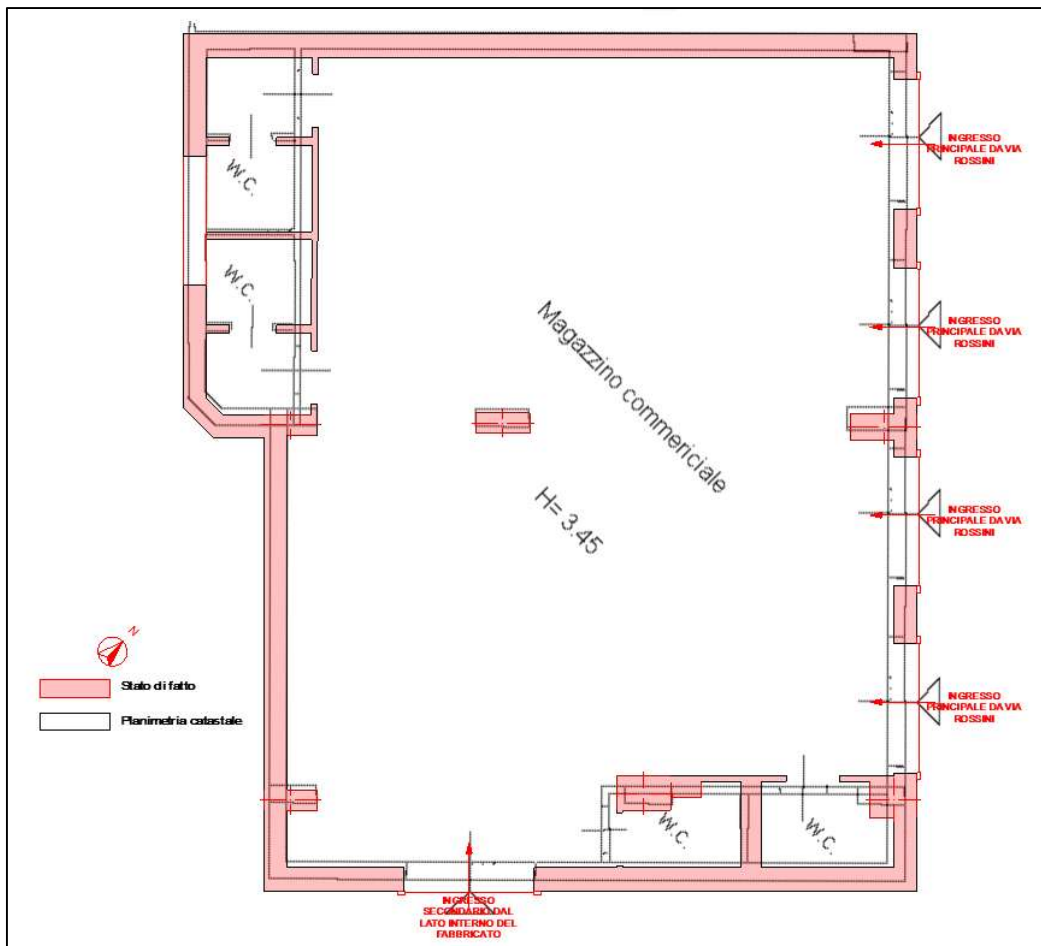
Sovrapposizione visura planimetrica catastale del locale commerciale pignorato (foglio 31 particella 809 sub 58) e rilievo effettuato in fase di sopralluogo
